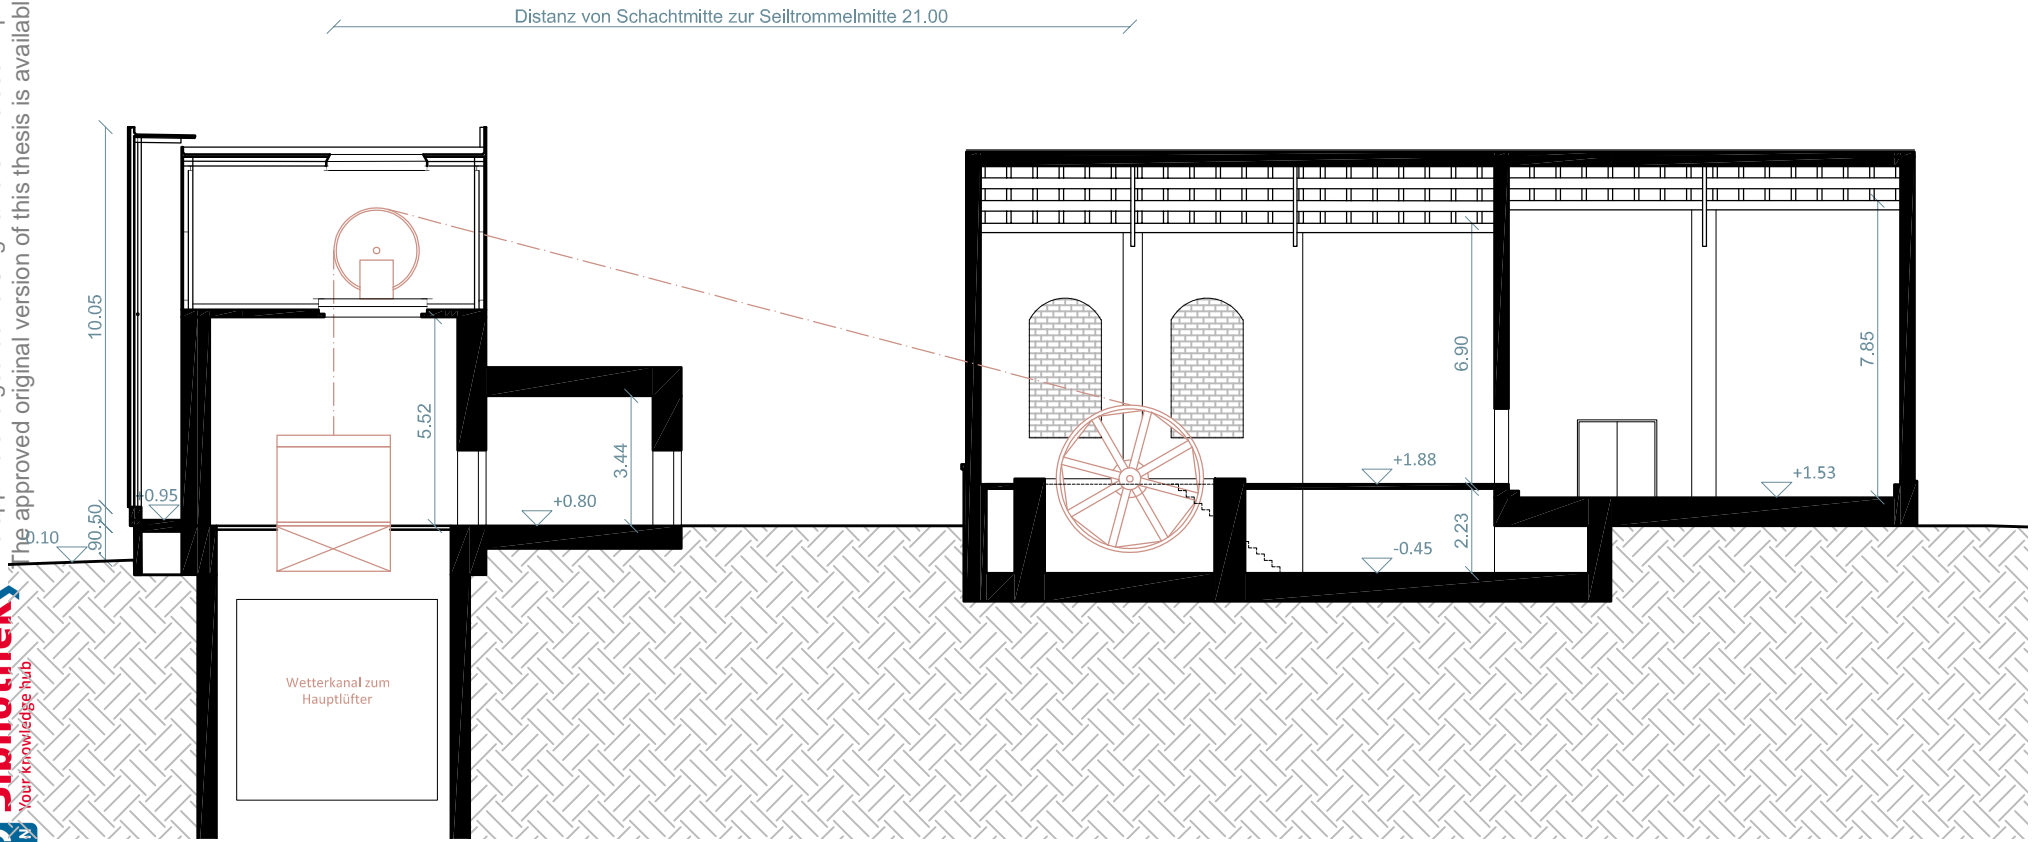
Schnitt A-A, Schachthalle und Fördermaschinenhaus, M 1:200
